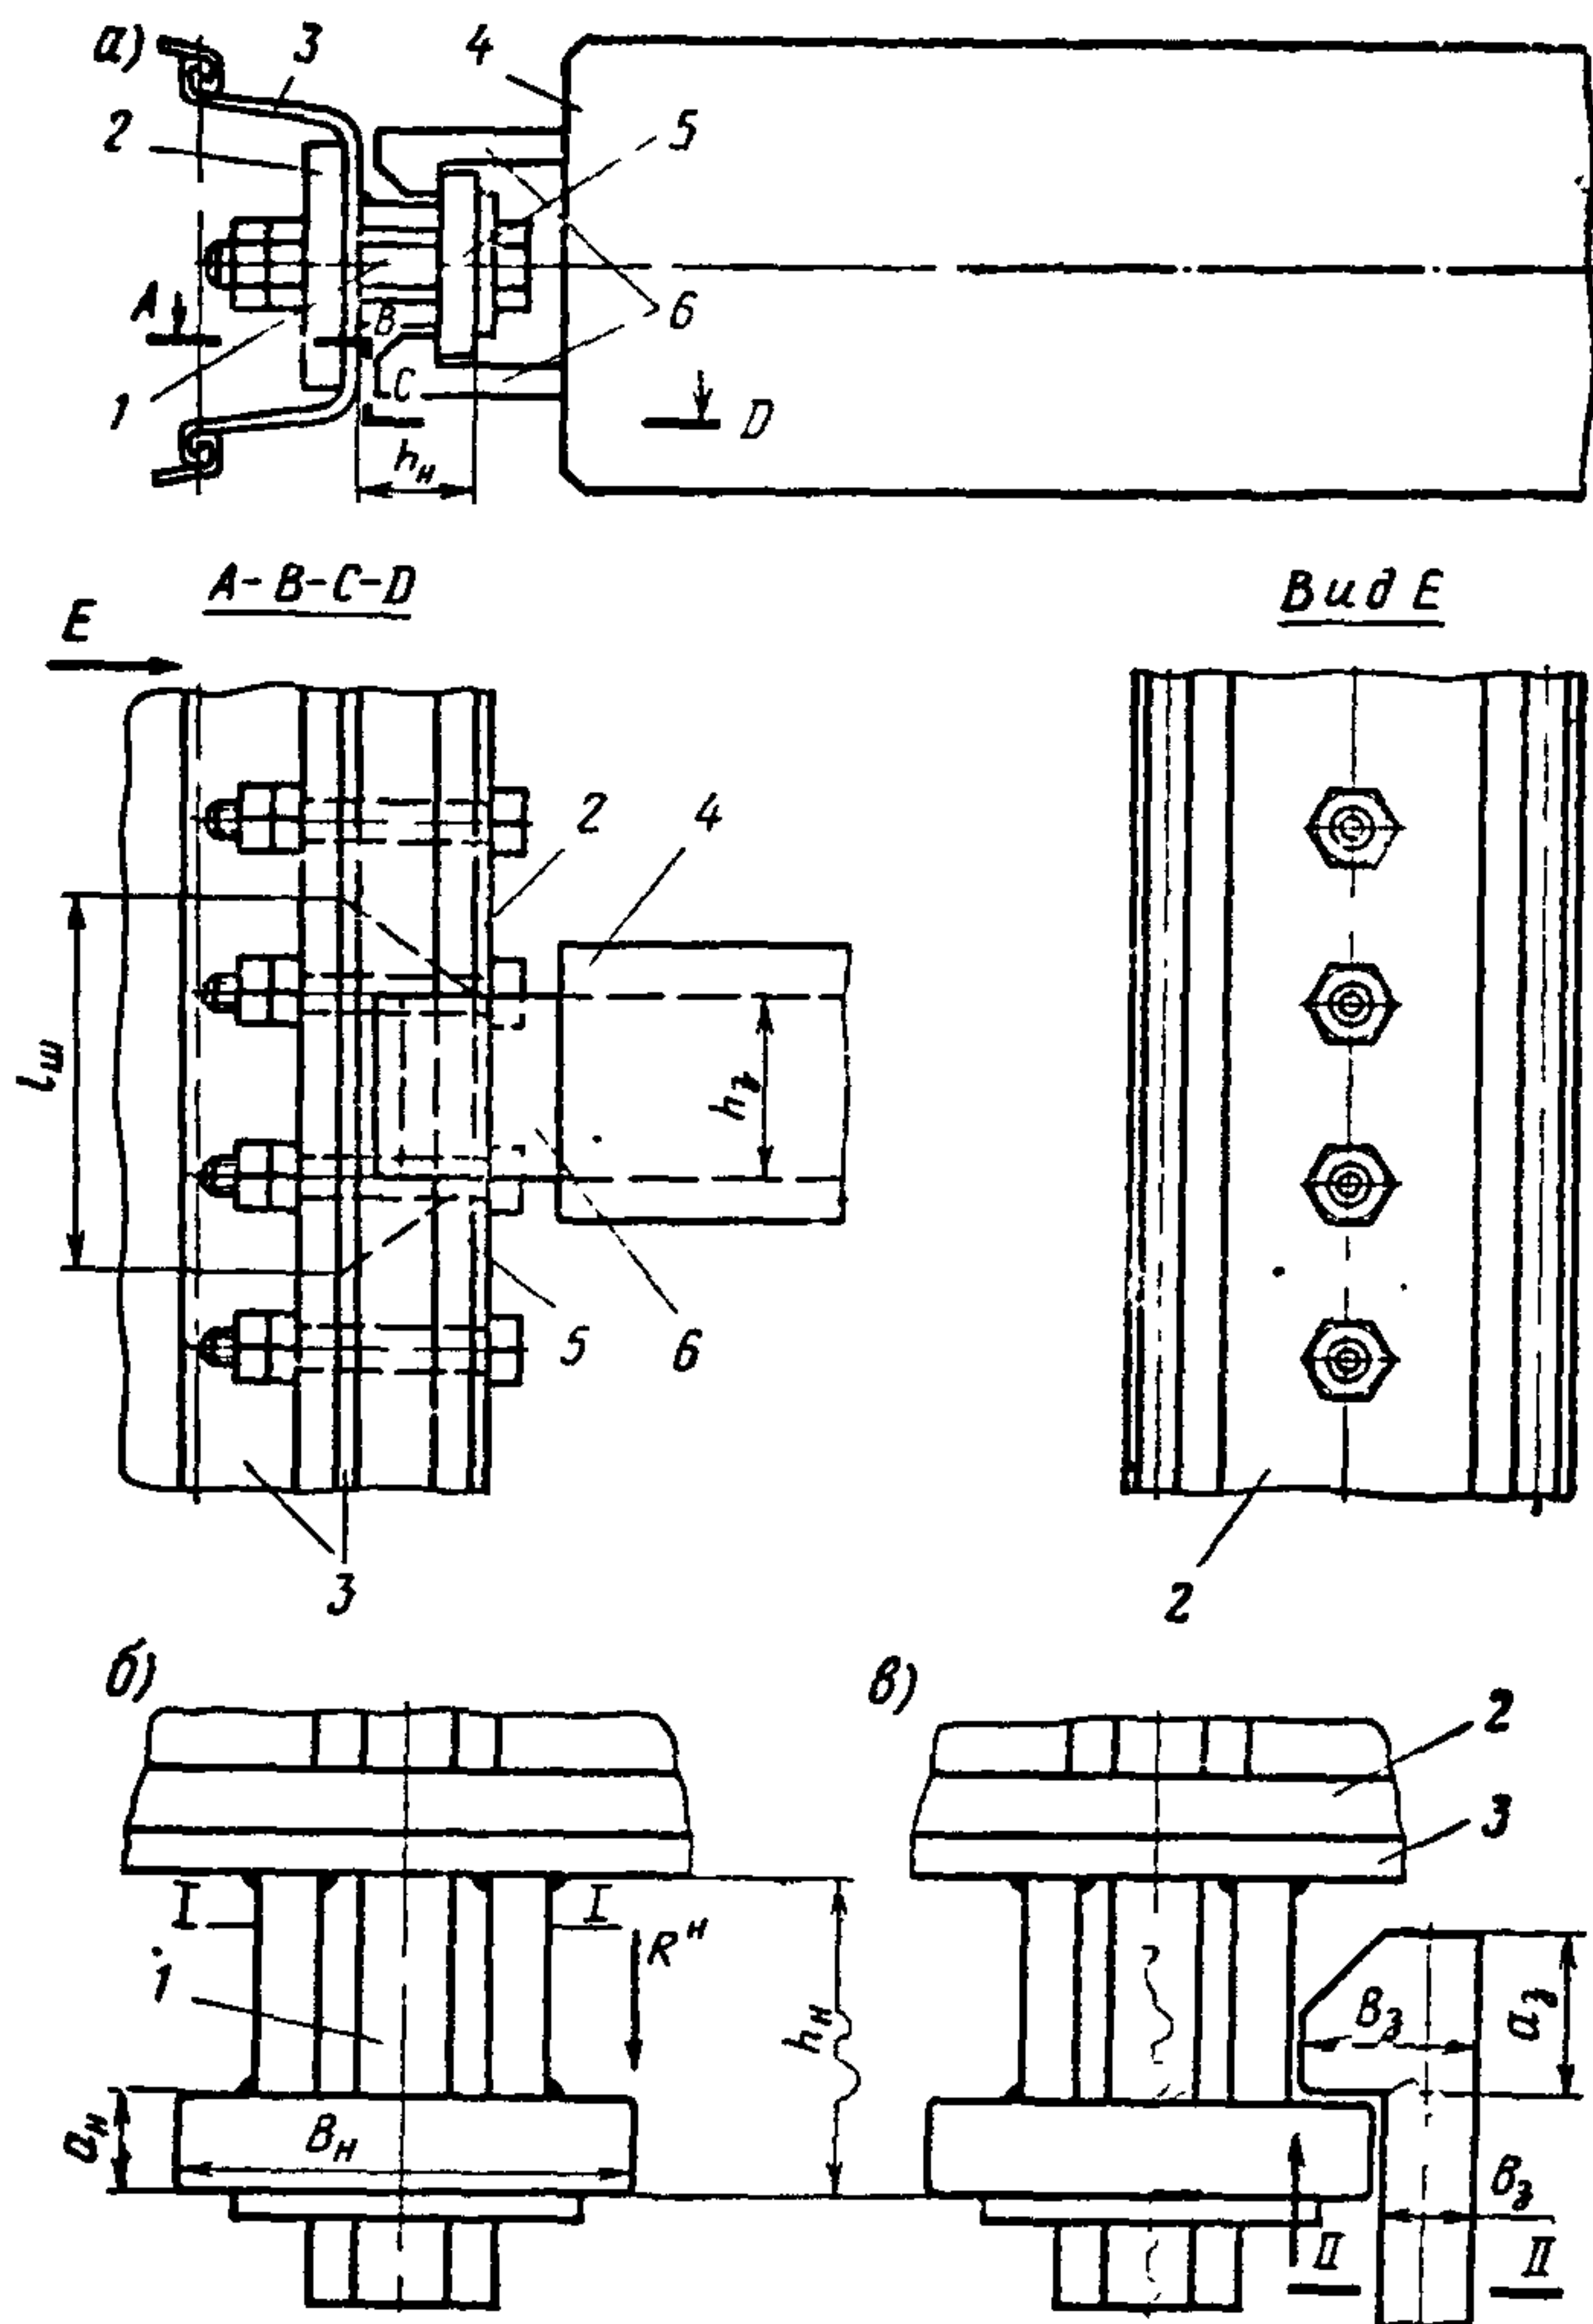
Крепление анкерной плиты к шпунтовой стенке с помощью болтов
